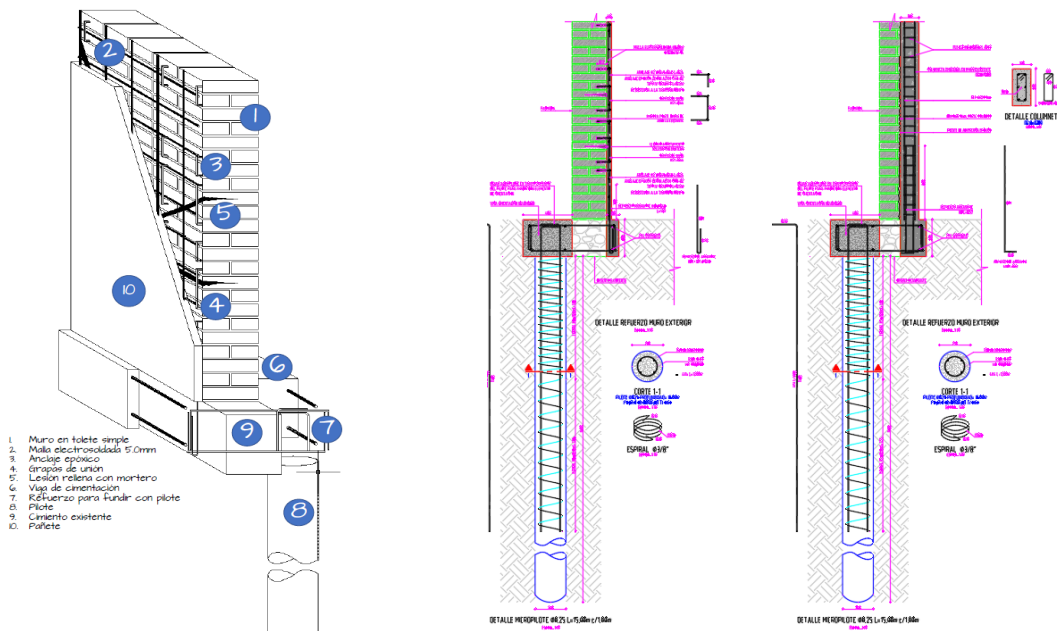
Propuesta de intervención reforzamiento cimentación y muros de fachada.
